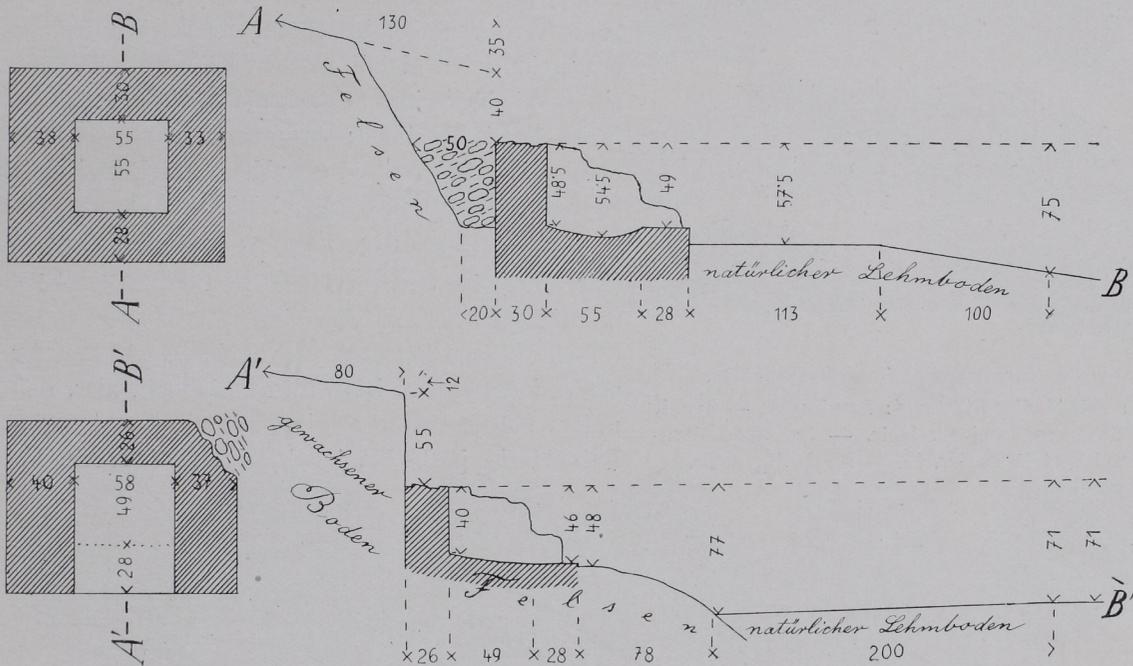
Grundrisse und Längsschnitte der Schmelzöfen: A—B von Fig. 36, A'—B' von Fig. 37. Maße in Zentimetern.
